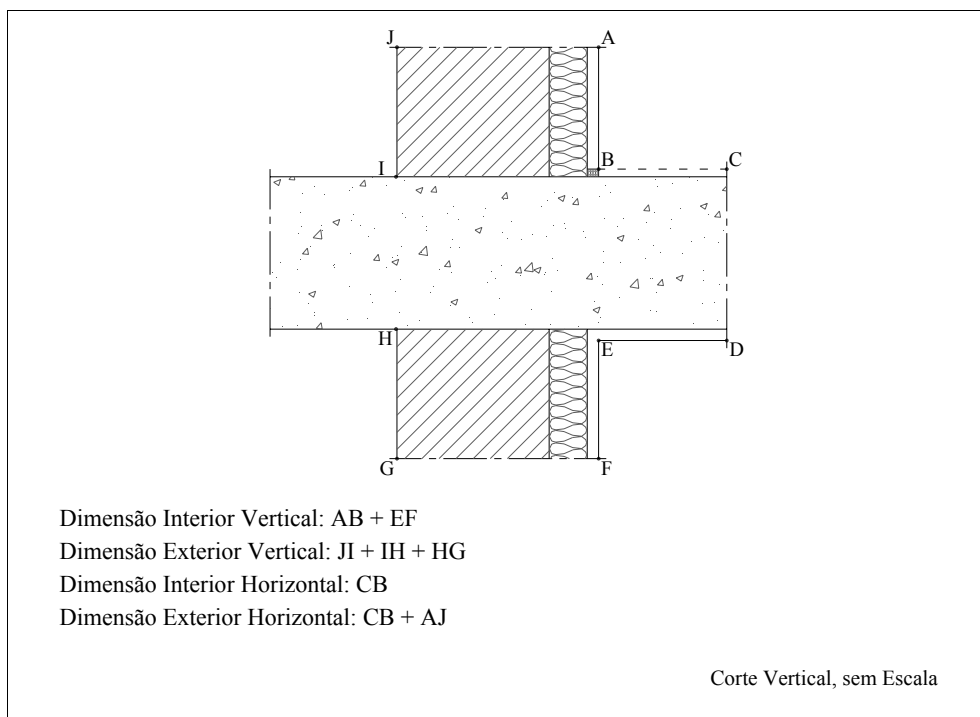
Exemplo 2 da utilização de dimensões interiores ou exteriores [30]
